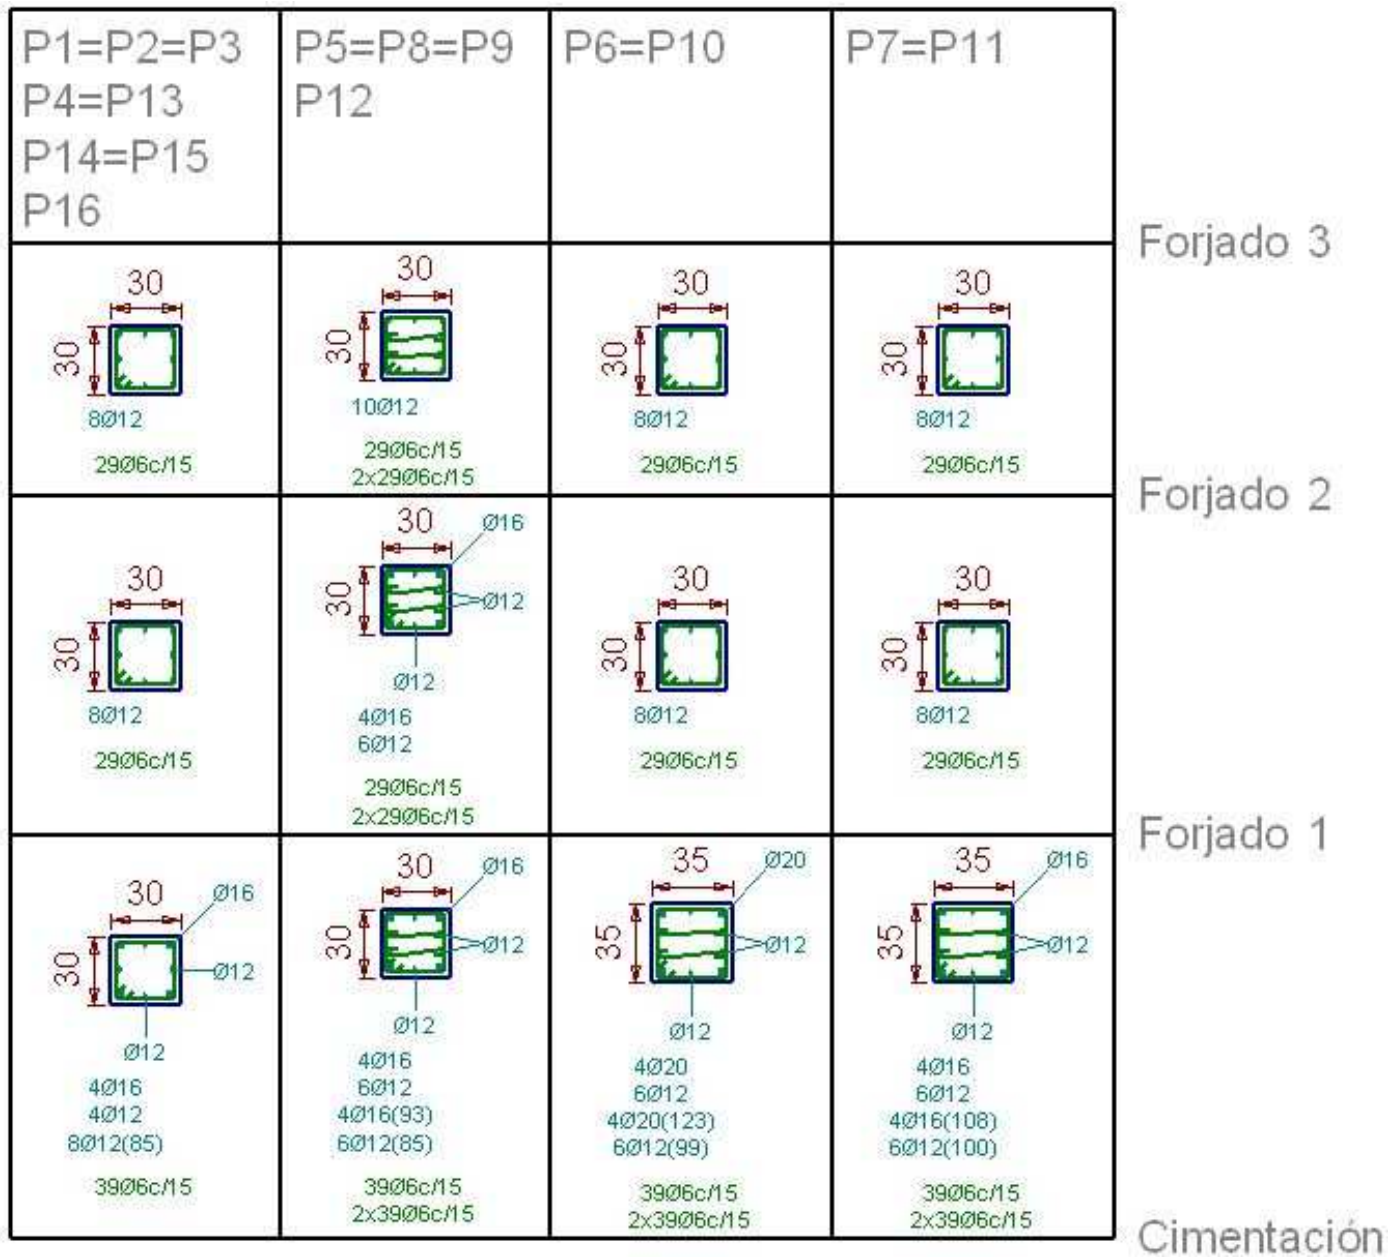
Armadura en pilares. Edificio de 3 plantas (G).
